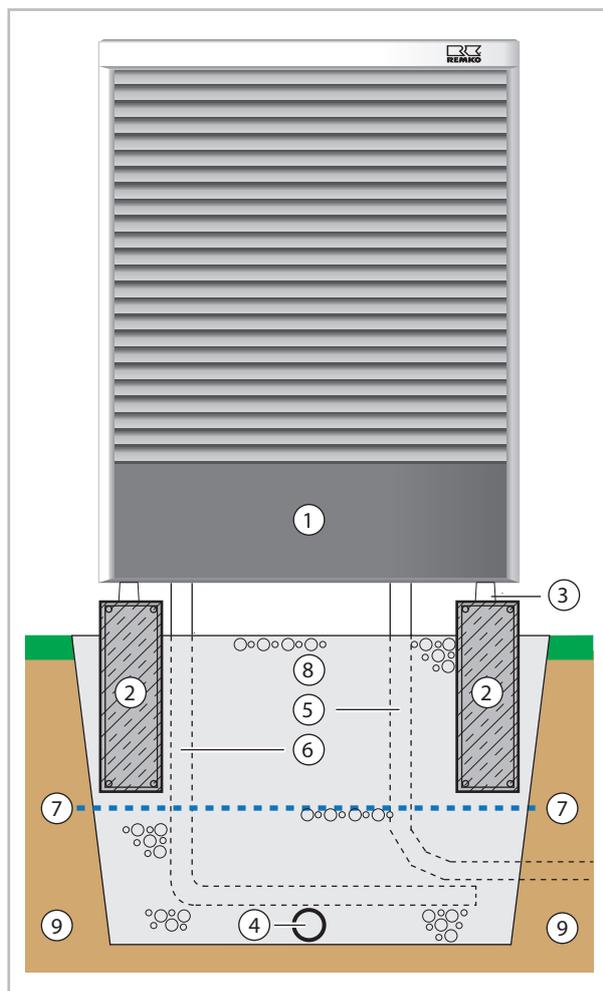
Conduite de condensat, évacuation de condensat et fondations de bande (coupe)
